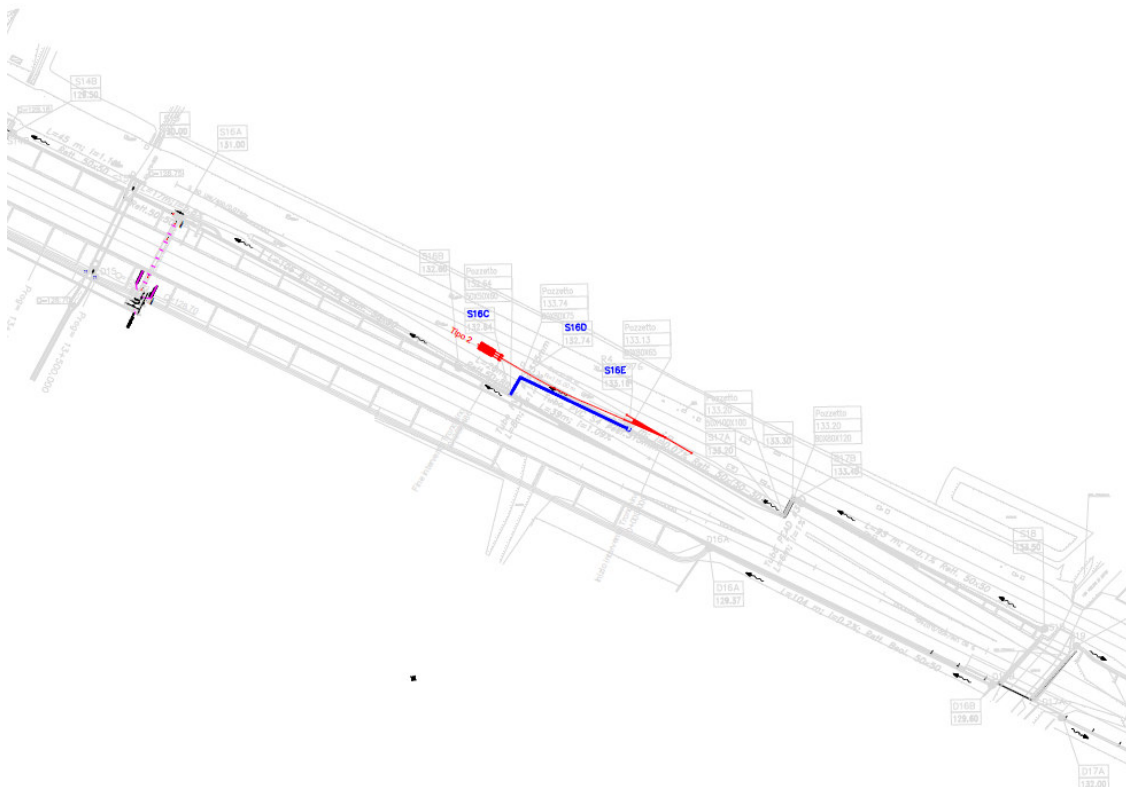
Ubicazione su planimetria del tratto della rete di drenaggio oggetto di adeguamento
